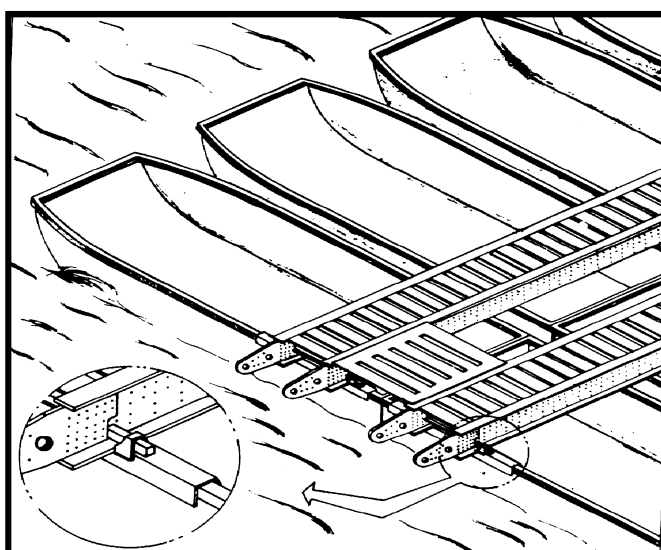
Posicionamento correto do primeiro par de painéis de rolamento
